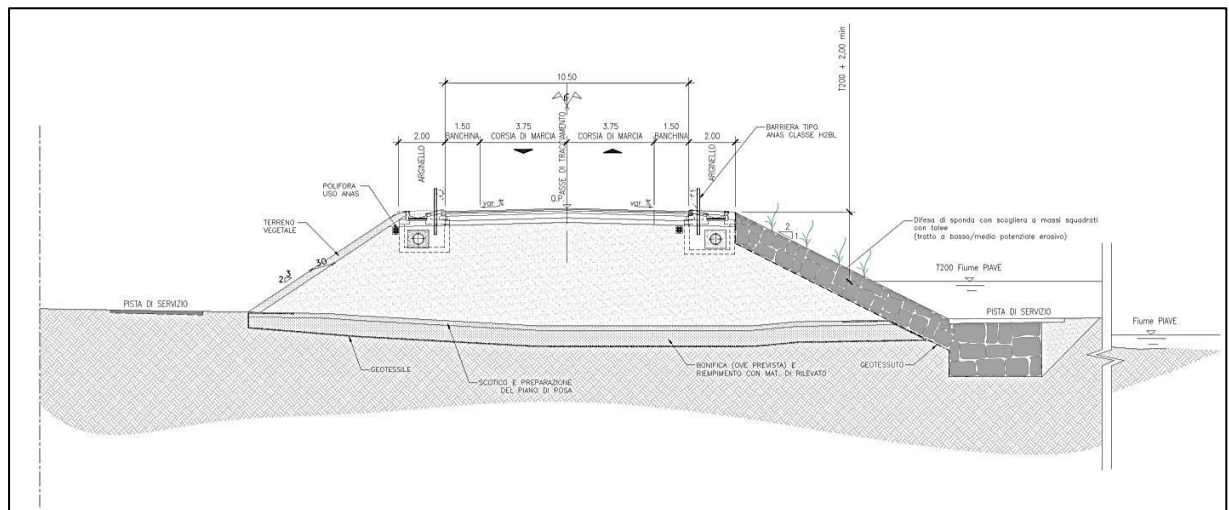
Sezione tipo C1 con difesa spondale a massi tratto a basso/medio potenziale erosivo.
